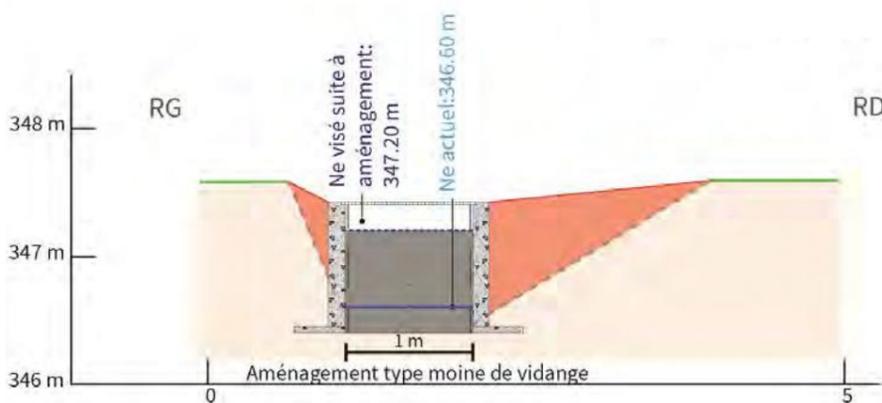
coupe de principe de l'installation d'un ouvrage hydraulique sur un fossé au bois des Brus (coupe 2)
